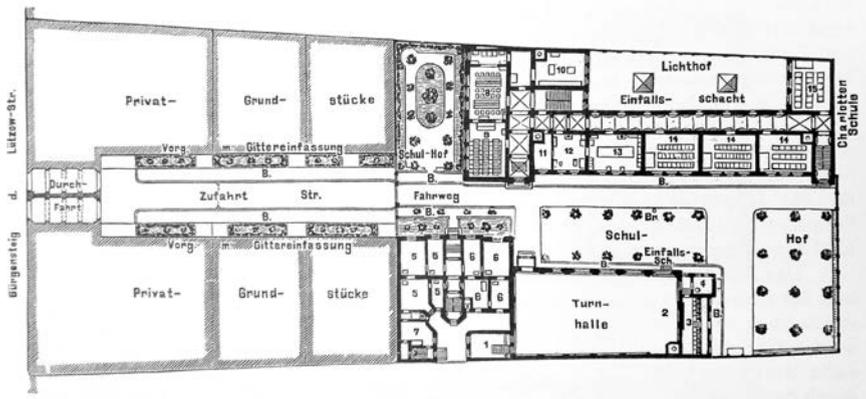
Lageplan Falk-Realgymnasium und Charlottenschule, erbaut 1878,
